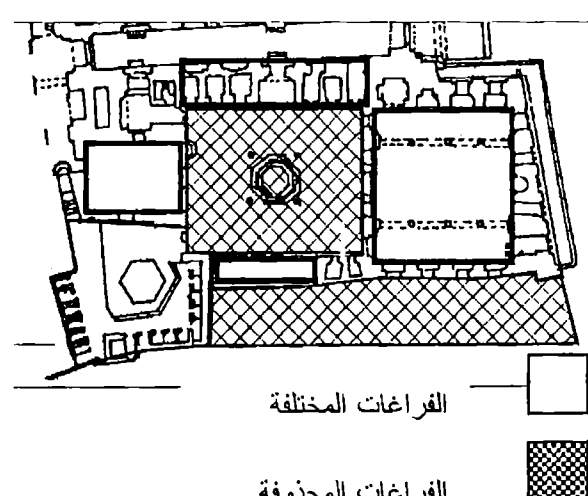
مسقط أفقي مدرسة وضريح قلاوون [89:161]
